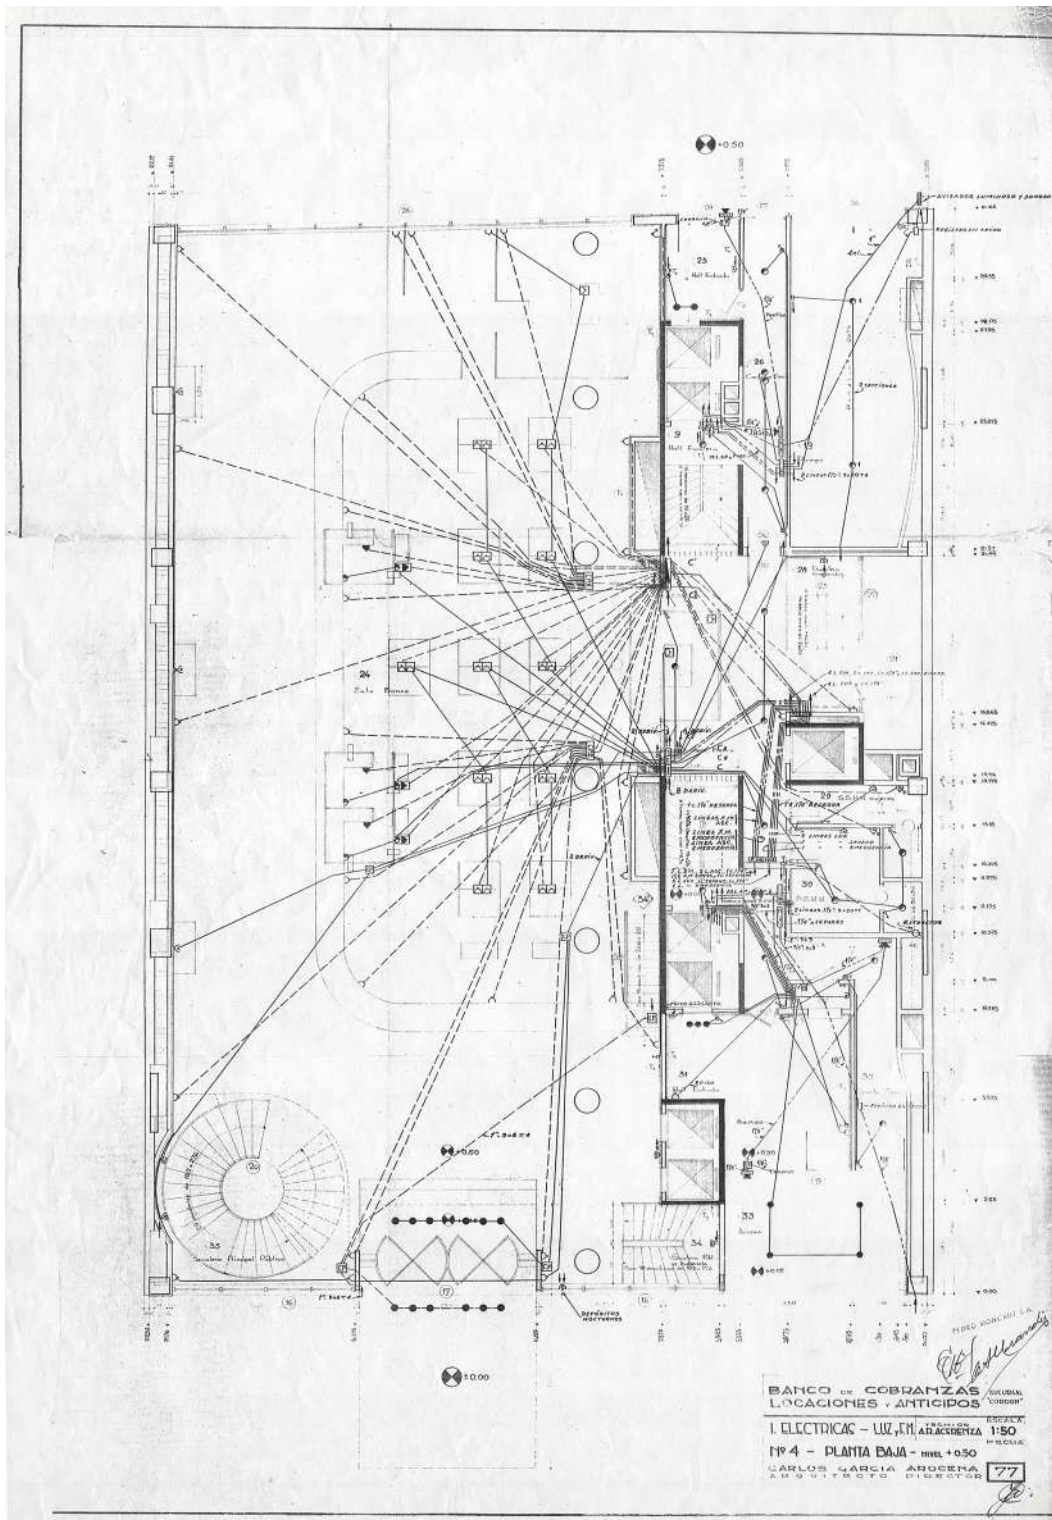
Lámina 77 del proyecto ejecutivo del BCLA: proyecto eléctrico de luz y fuerza motriz de planta baja.
